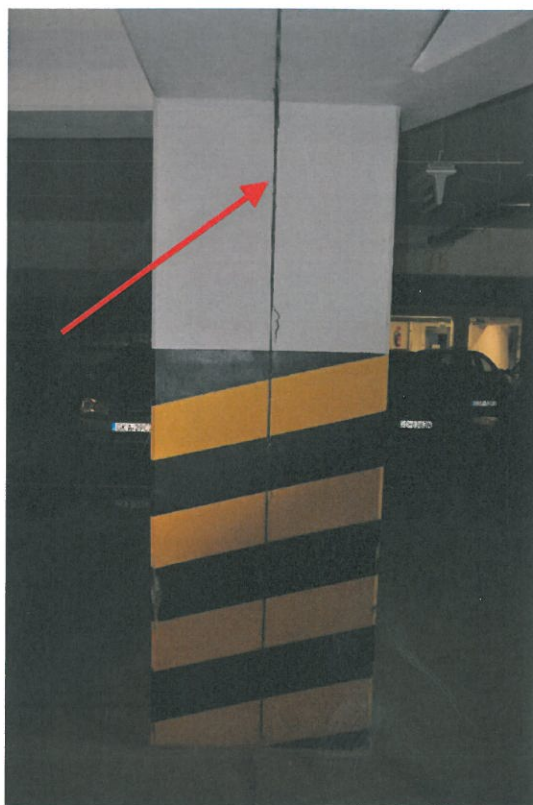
Widoczne pęknięcia ściany w okolicach przepustu dachowego.
